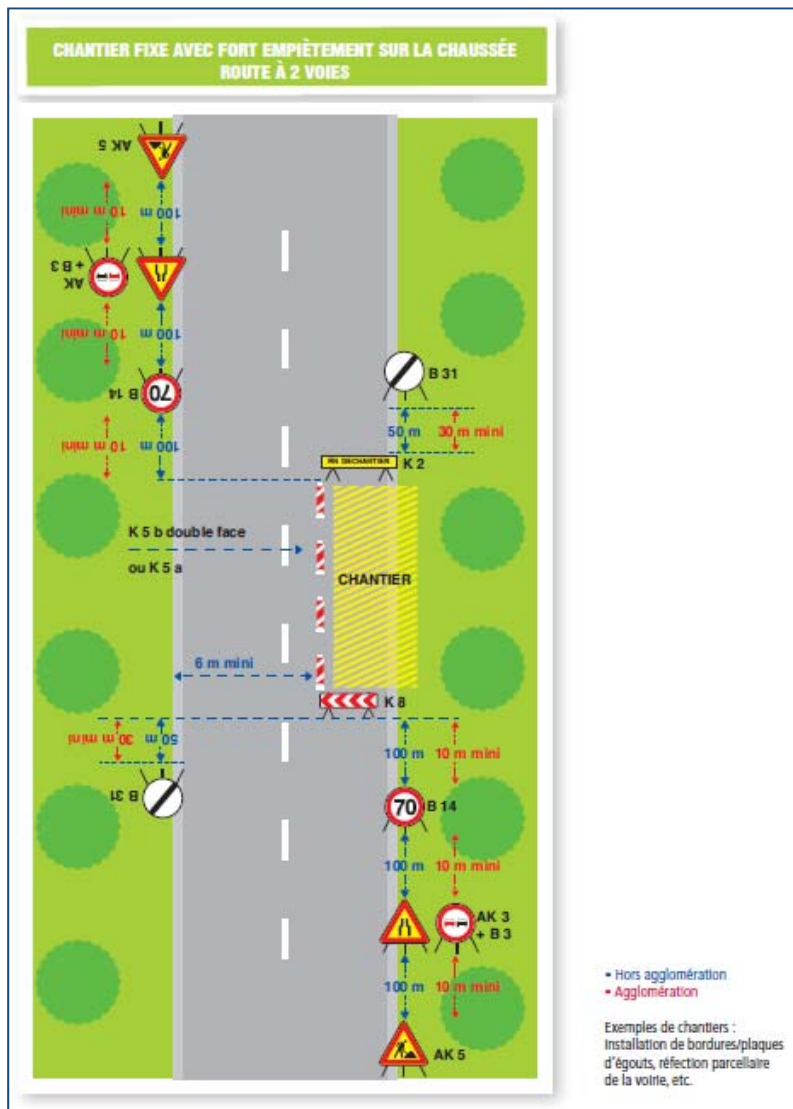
Exemple de signalisation temporaire d'un chantier fixe avec fort empiètement sur la chaussée
